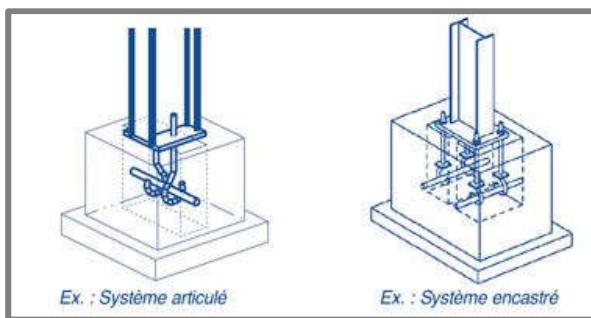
Exemple de poteau métallique avec fondation en béton armé.
